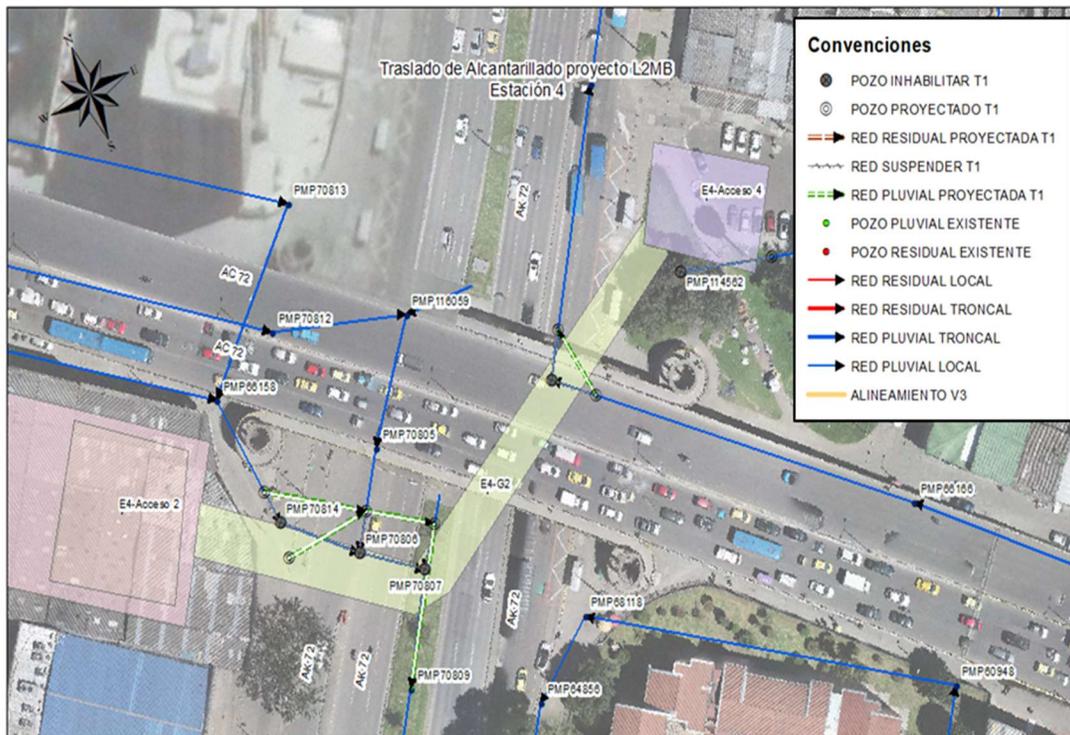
Traslado redes de alcantarillado Estación 4 Calle 72 con Av Boyacá costado Oriente- Red Pluvial
